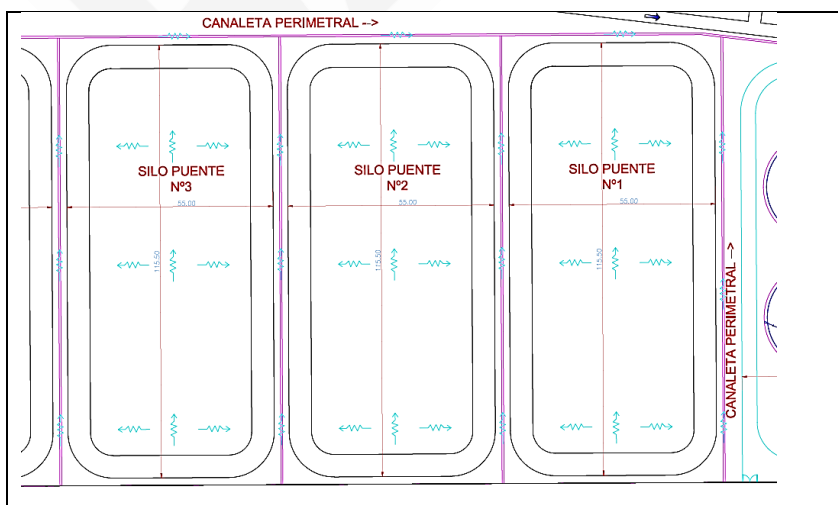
detalle del plano adjunto en el Anexo: plano de los silos de maíz.
